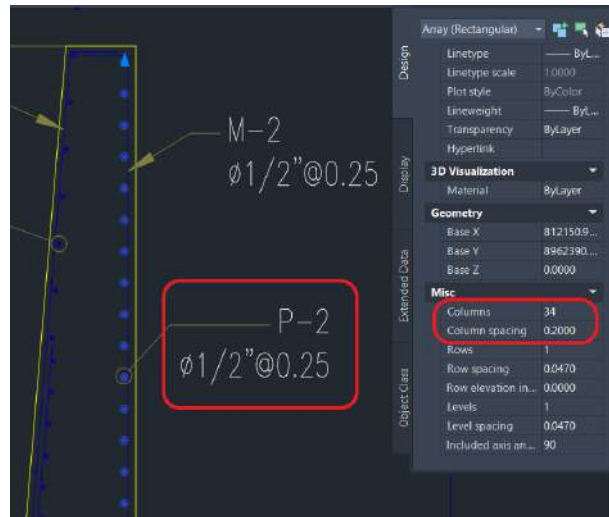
Vista de distribución de acero P-4 en el Muro de Contención 2 en el Estribo Izquierdo Aguas Abajo
